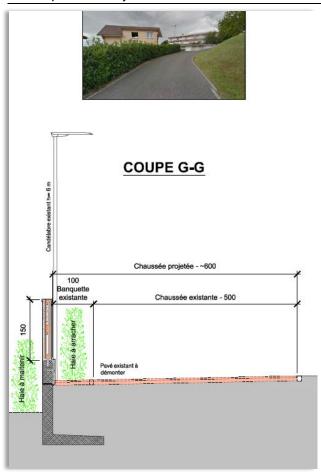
Coupe G sur parcelle RF n° 949 (arrachage haie existante – élargissement
